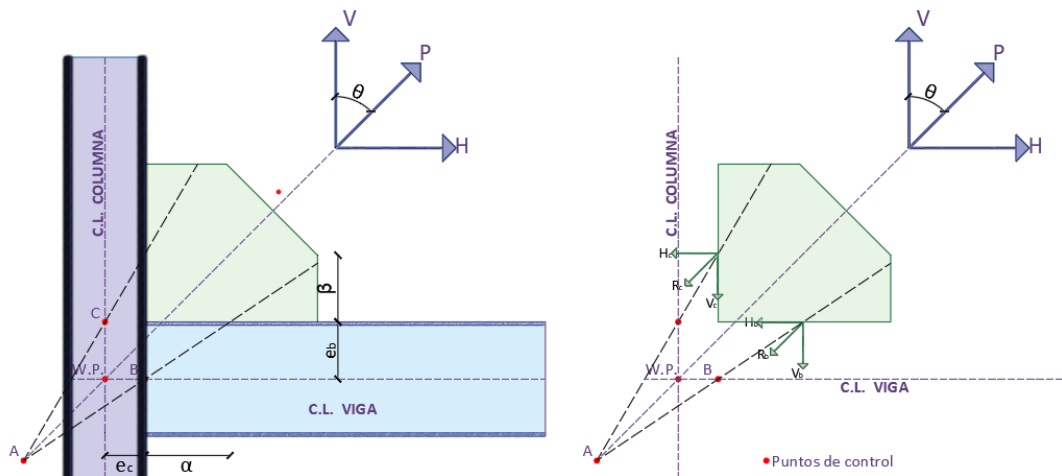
Cordón de soldadura del área de refuerzo- arriostramiento superior.
